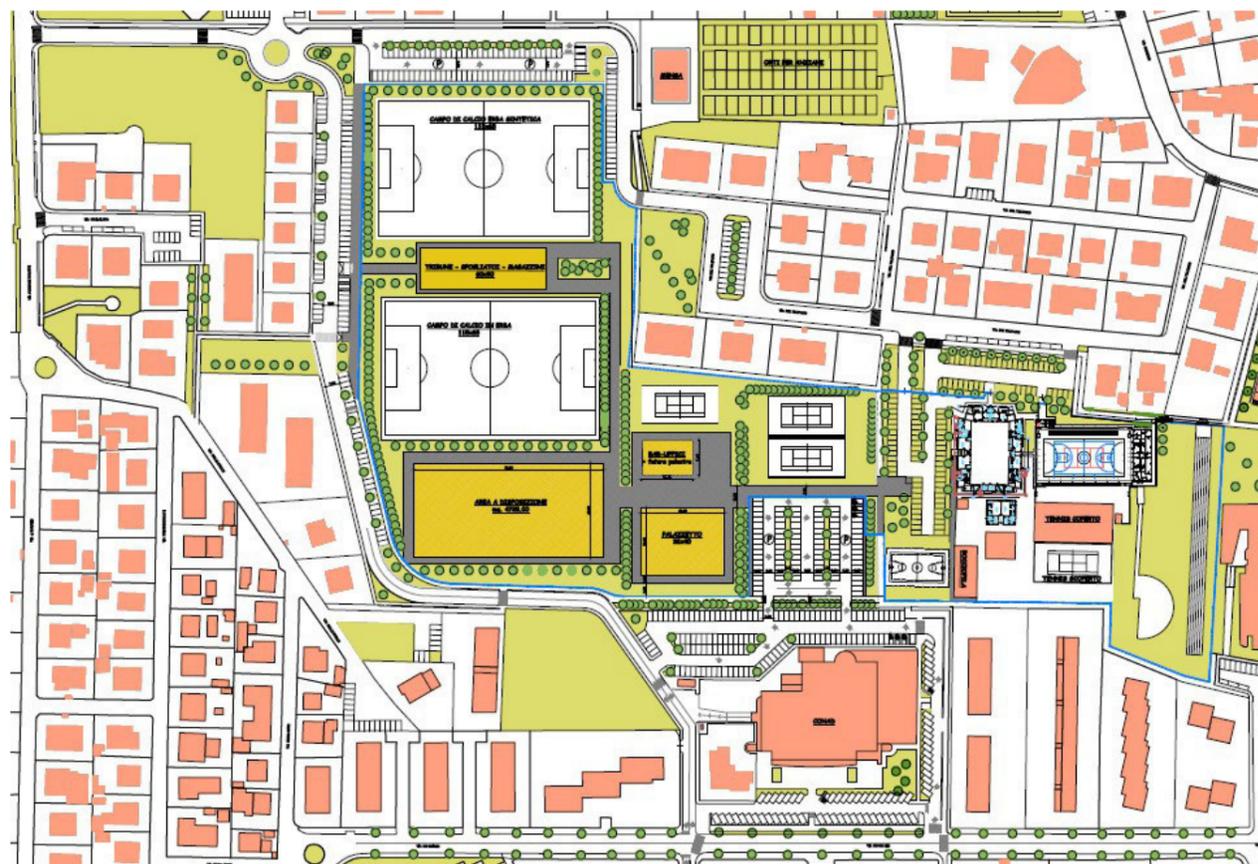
Ipotesi progetto ampliamento Polo Sportivo
